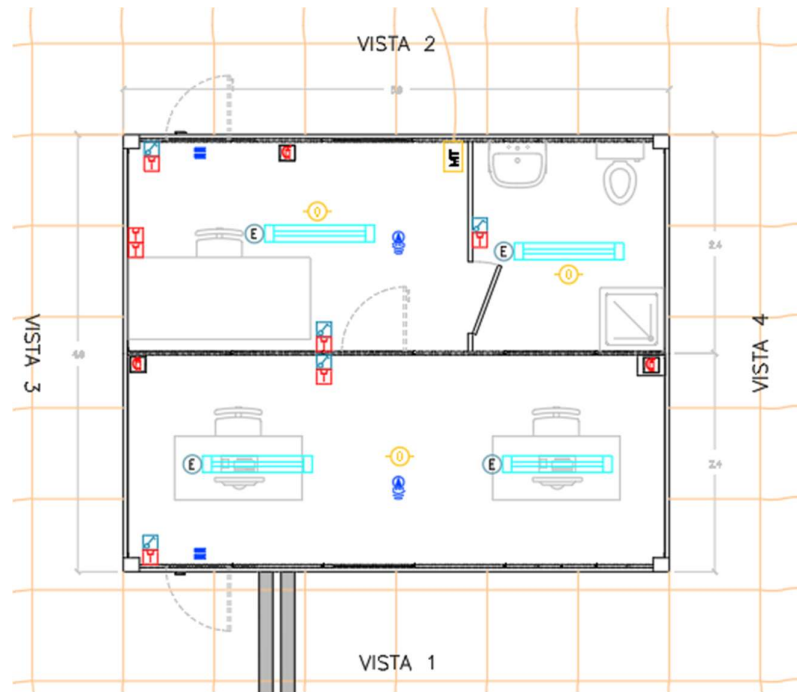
Posizionamento plafoniere Cabina Uffici
